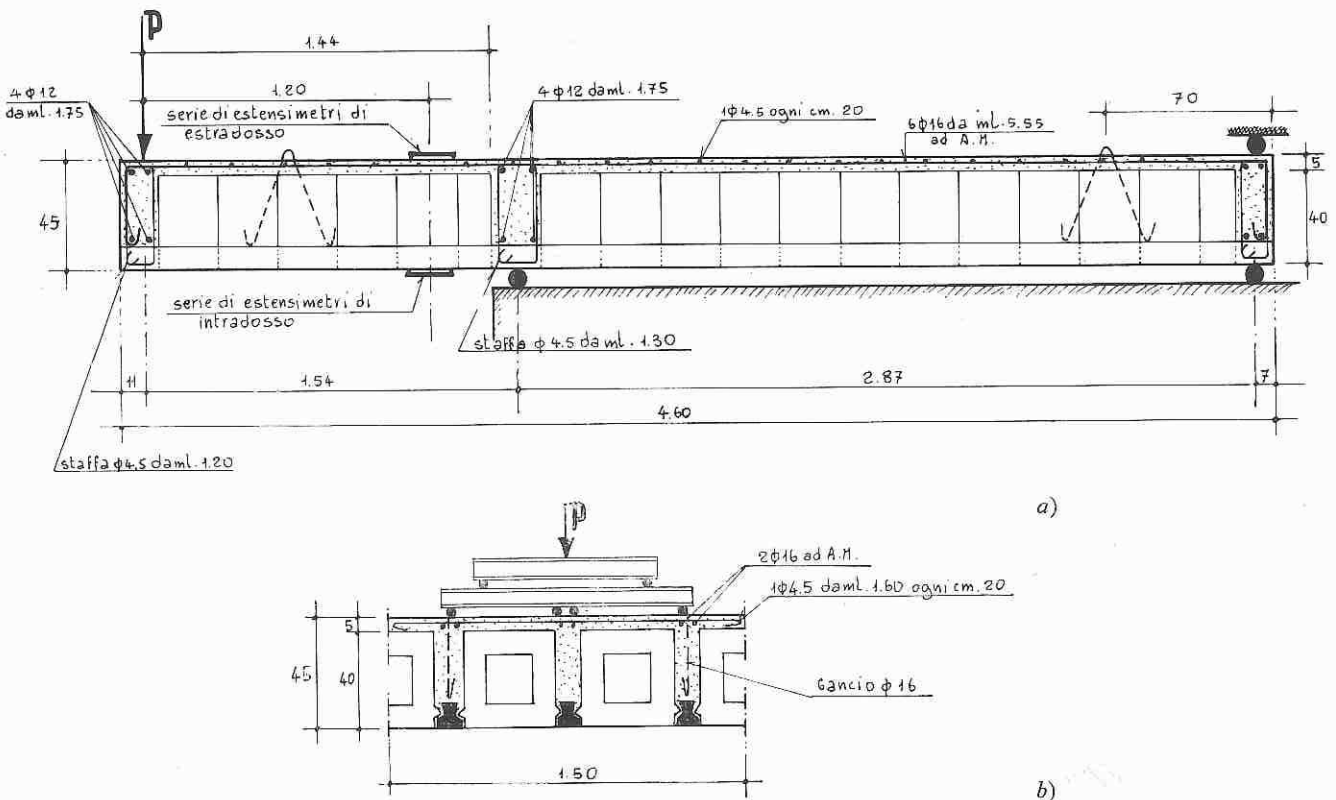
Strisce di solaio n. 1-2-3: prove a momento negativo: a) schema armatura, b) sezione trasversale.
